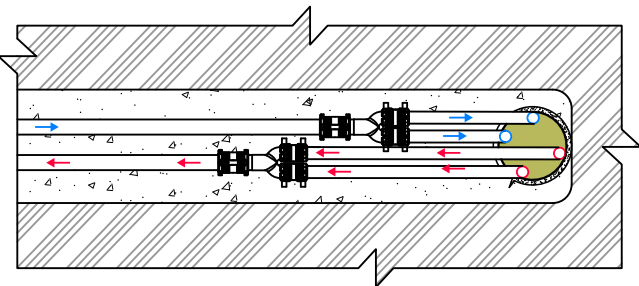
DETAIL VRATNÉHO U - KOLENA SE SEPARAČNÍ JÍMKOU M 1:5
